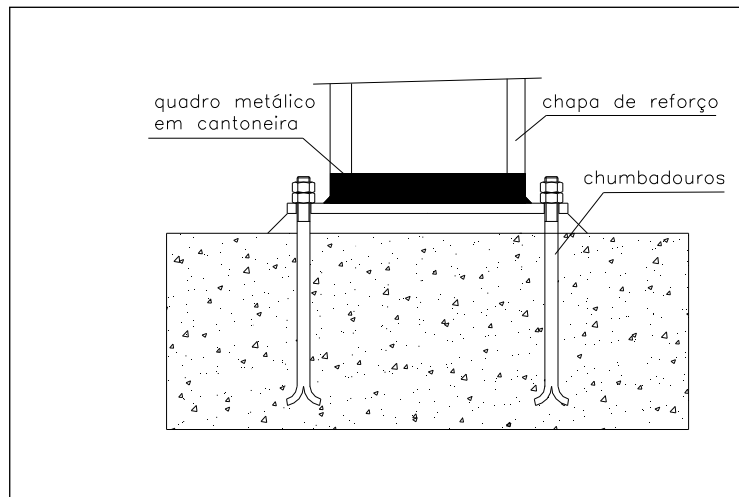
Ligação dos perfis de reforço de pilares à sua fundação [31].
